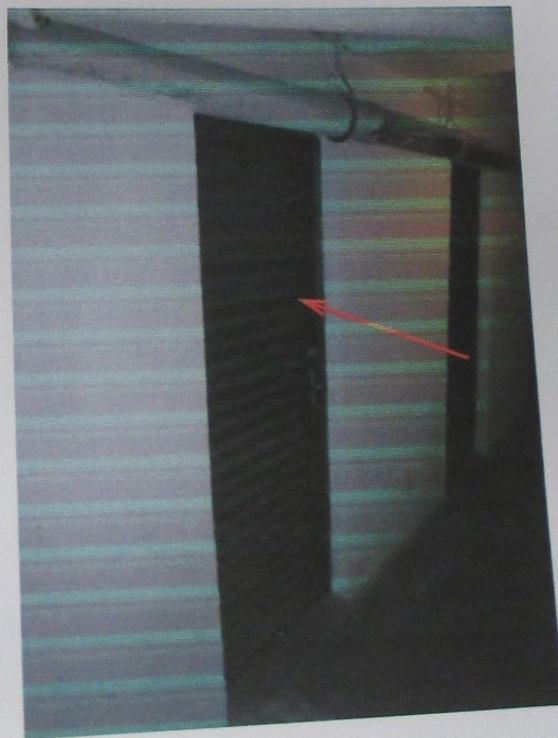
O depósito nº 7 está localizado no 2º pavimento inferior (-2) para uso do apartamento avaliando. Possui uma área de 6,00 m² (2,00 m x 3,00 m) e paredes azulejadas até o teto.
